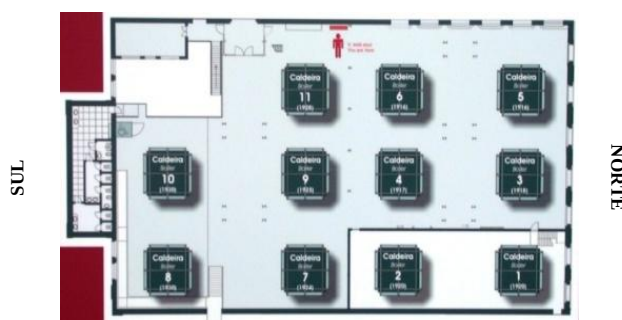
Planta de disposição das caldeiras de BP (L.Cruz).
